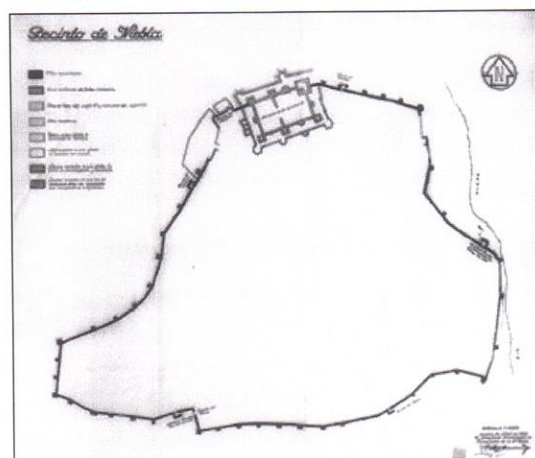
Plano de planta del recinto amurallado de Niebla (Huelva), procedente del proyecto de restauración firmado por Félix Hernández en abril de 1959
